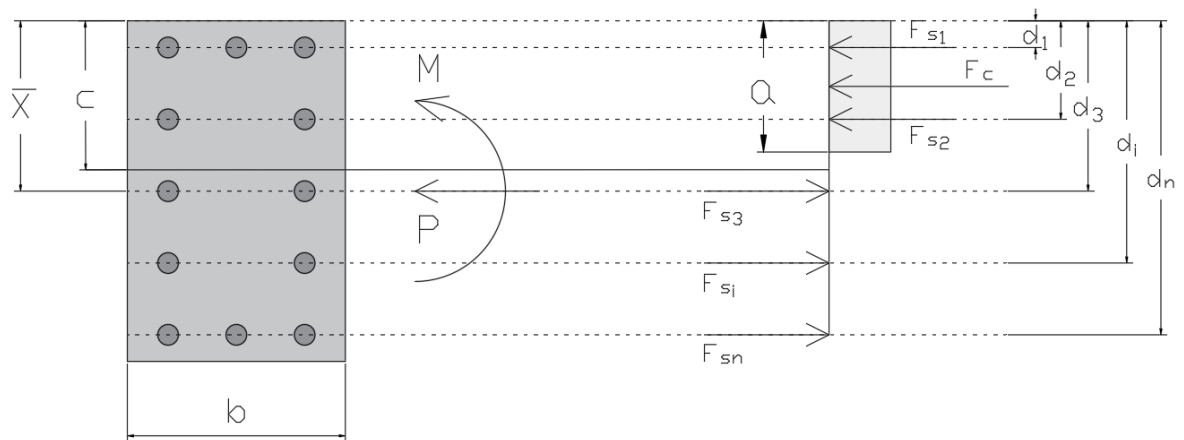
5: Fuerzas resistente de los materiales en una sección de hormigón armado
